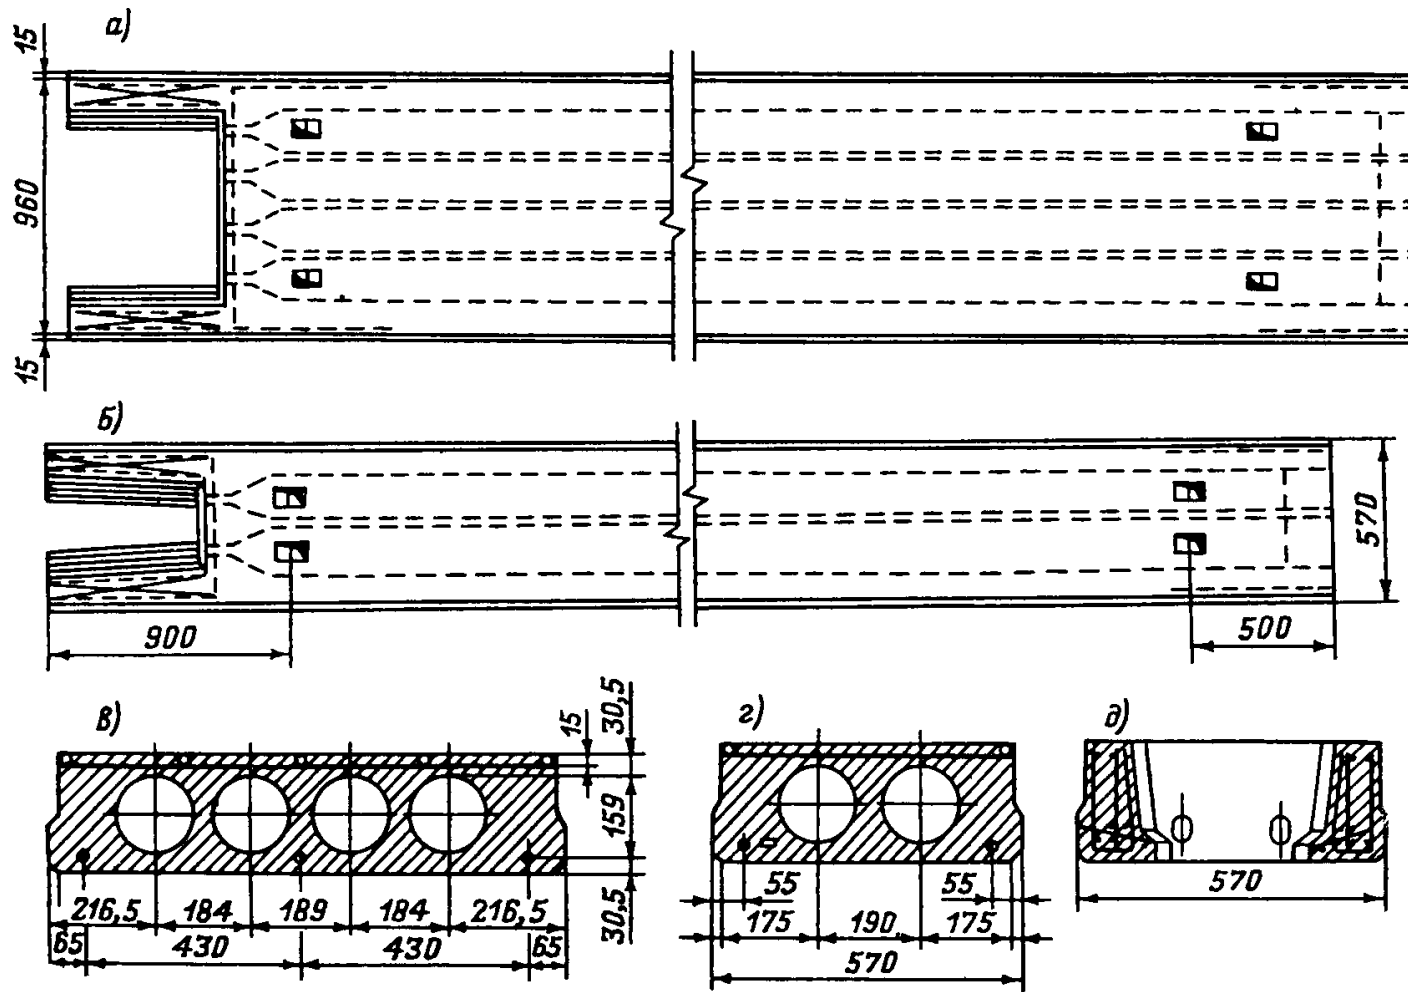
Московские настилы с выпускными ребрами и круглыми пустотами (планы и сечения):
